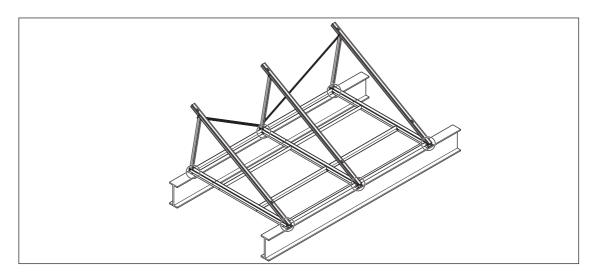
Fissare la struttura per tetto piano libera tramite la sottostruttura
